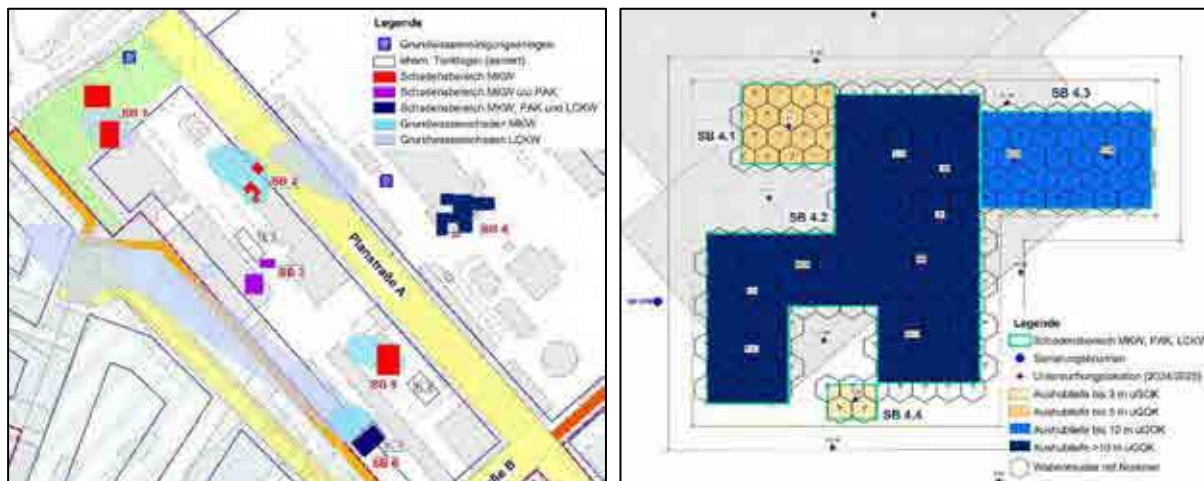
Übersichtslageplan Sanierungsbereiche 1-6 und Detaillageplan Sanierungsbereich 4 mit Aushubtiefen und möglicher Wabenanordnung, envi sann [8], modifiziert
